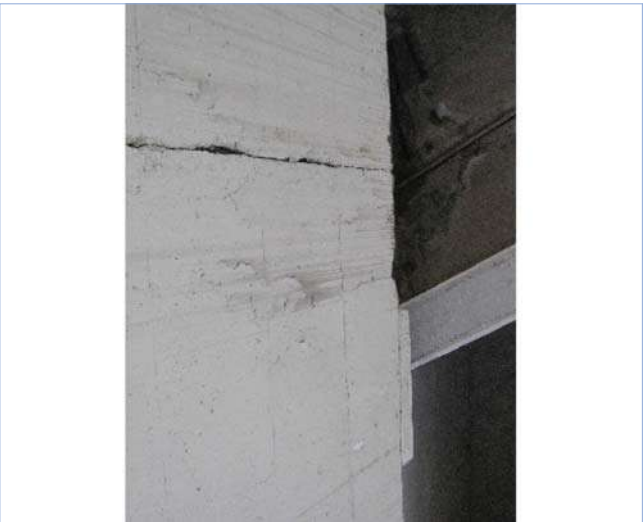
ZG4-446 IMG_5578 Fisura vertical E1
